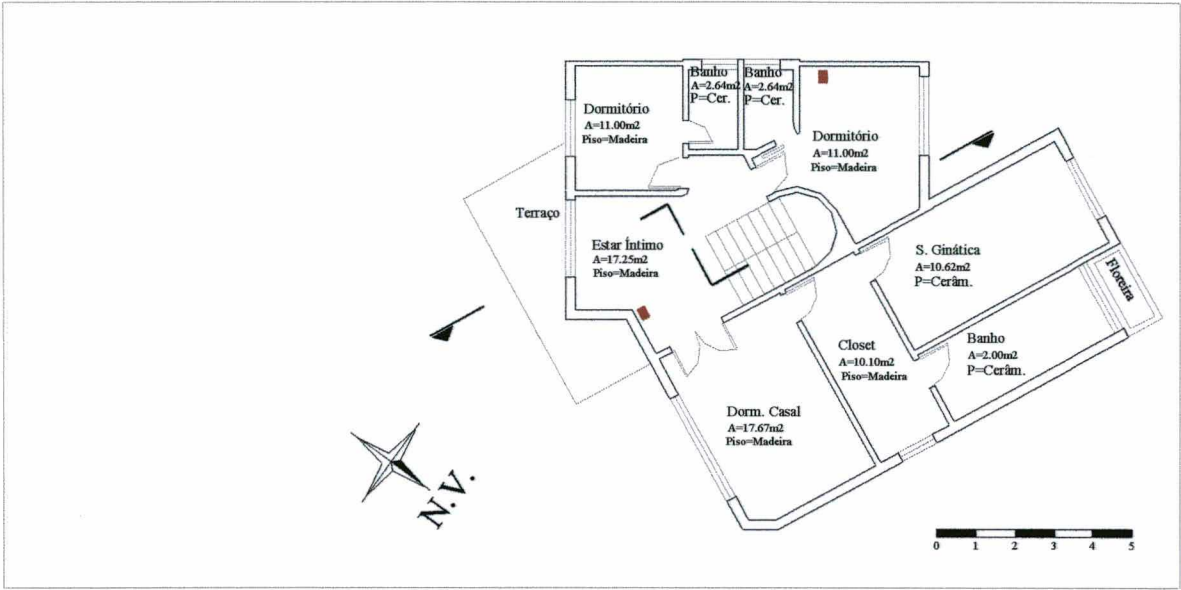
Planta Baixa Pavimento Superior Residência 1
